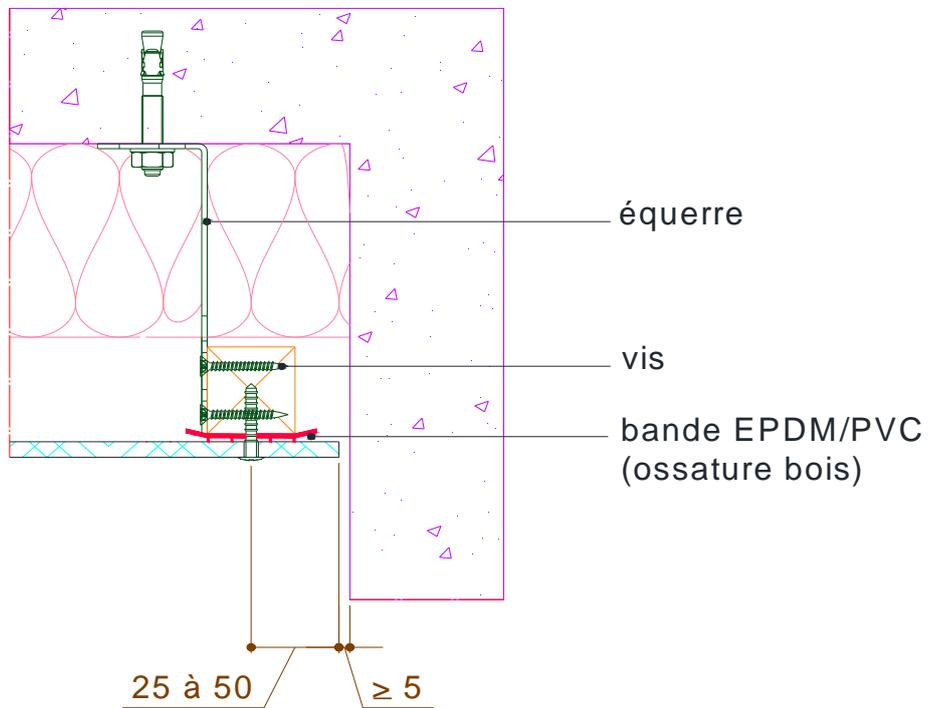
Détail connexion contre un mur sans bardage (coupe horizontale) sur ossature bois ou métallique (cote en mm)
